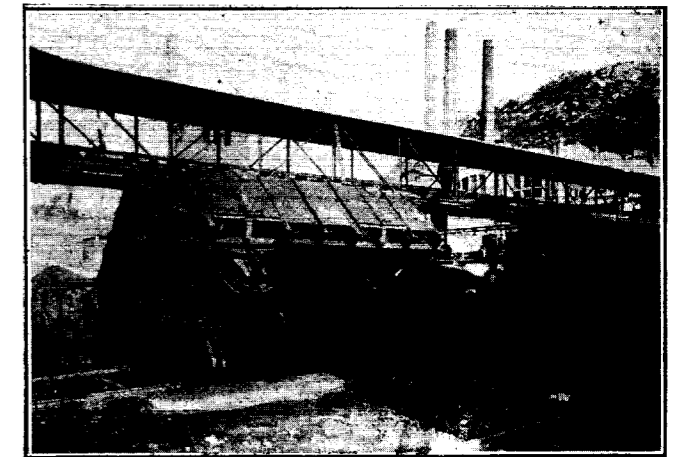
a. - Volcador visto por el lado opuesto a la descarga.
